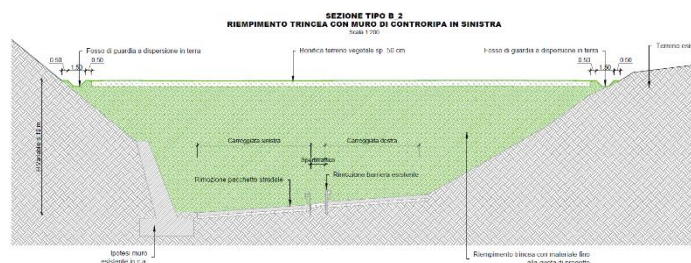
Sezione tipo B_2 riempimento trincea con muro in sinistra
